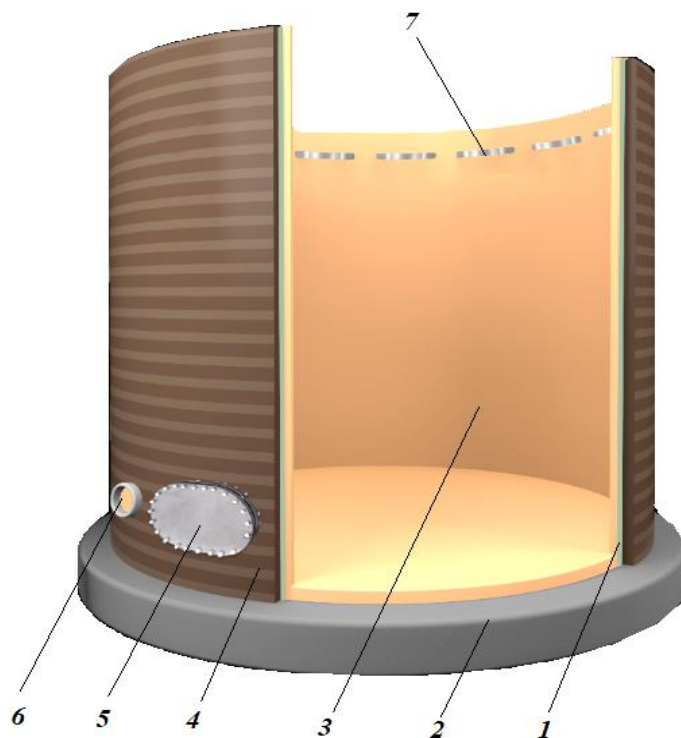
Полімерний вкладиш встановлений в резервуарі:
